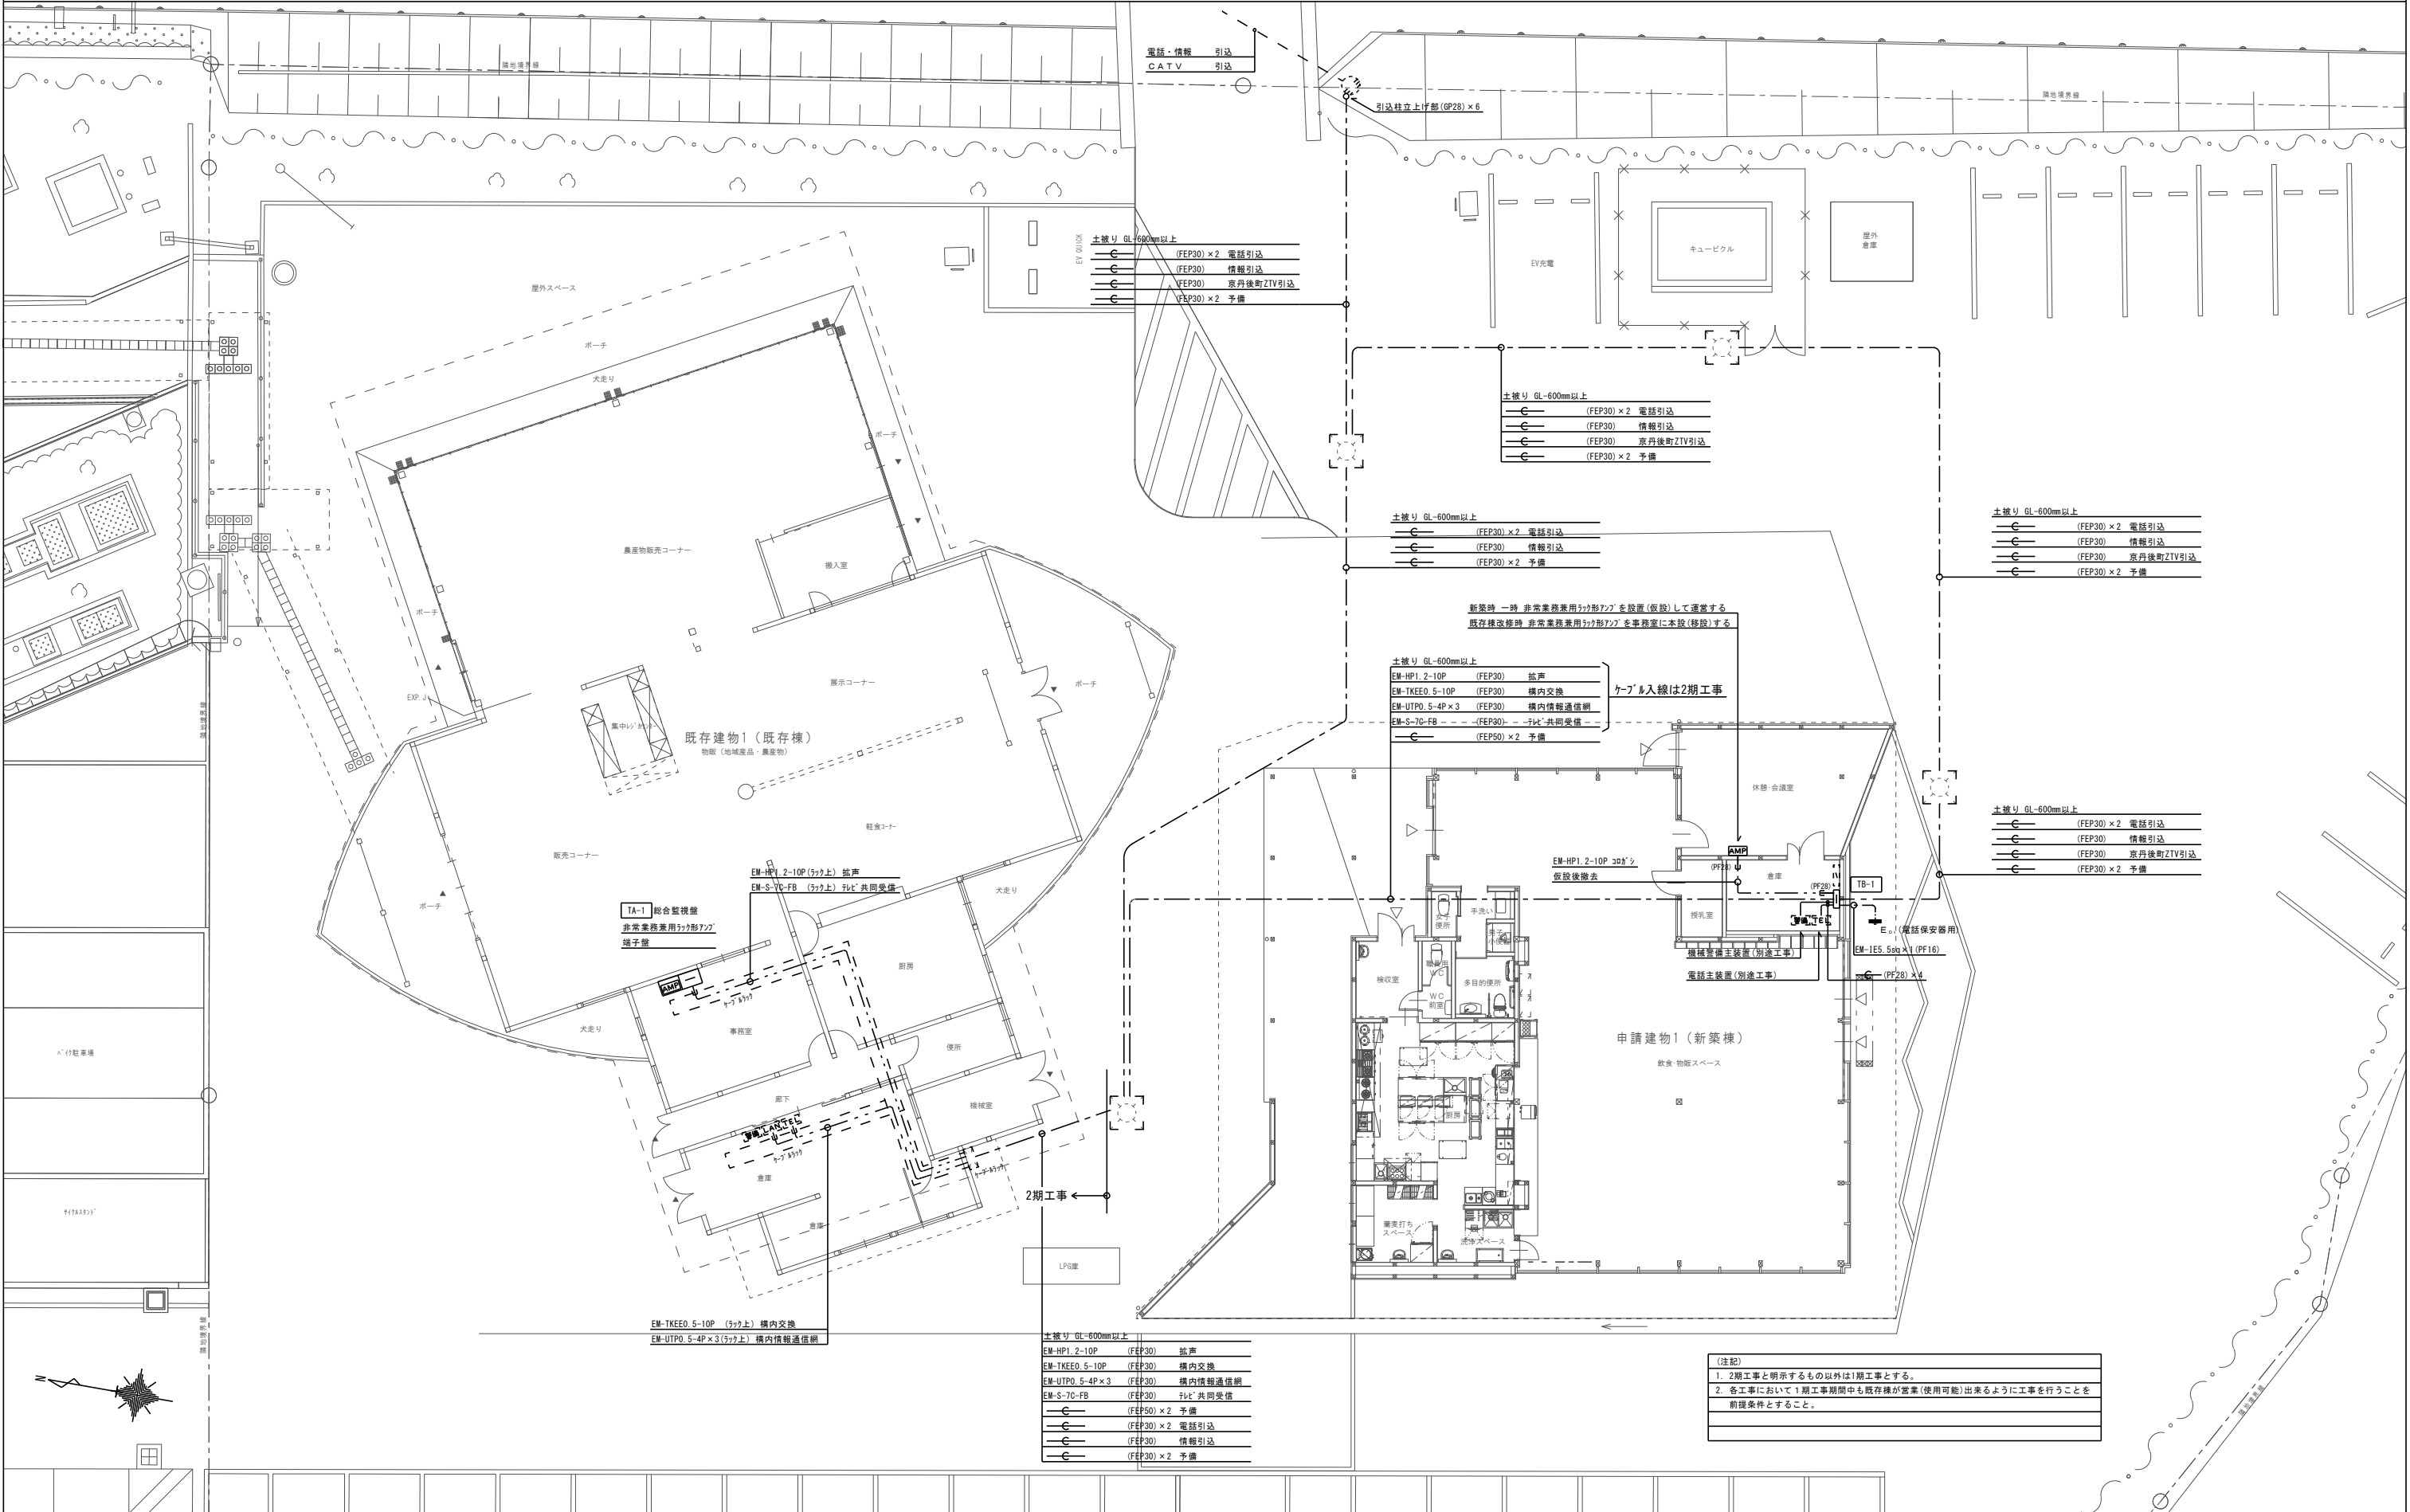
期工事(新築棟新築工事) 電灯(非常用照明・誘導灯)設備 平面図
